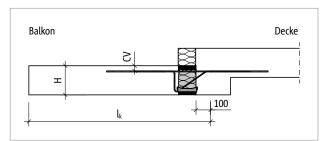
Schöck Isokorb® XT Typ K-M1 bis M8: Statisches System
